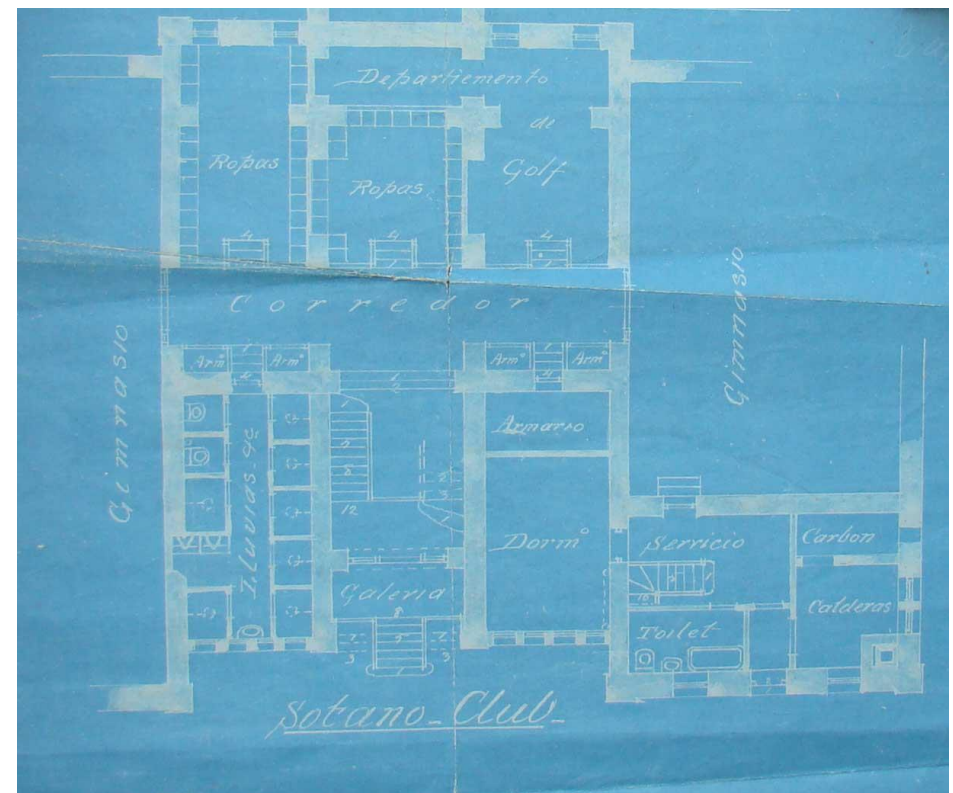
Sub-Solo, 09-12-1918, Prancha n.98. Acervo: Clube Campestre.
